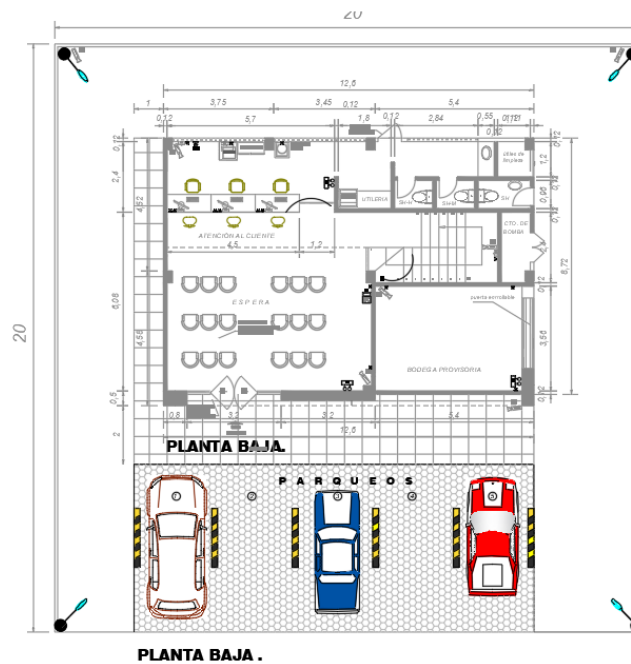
Distribución interna correspondiente a la planta baja y exteriores de la Agencia Naranjito.
